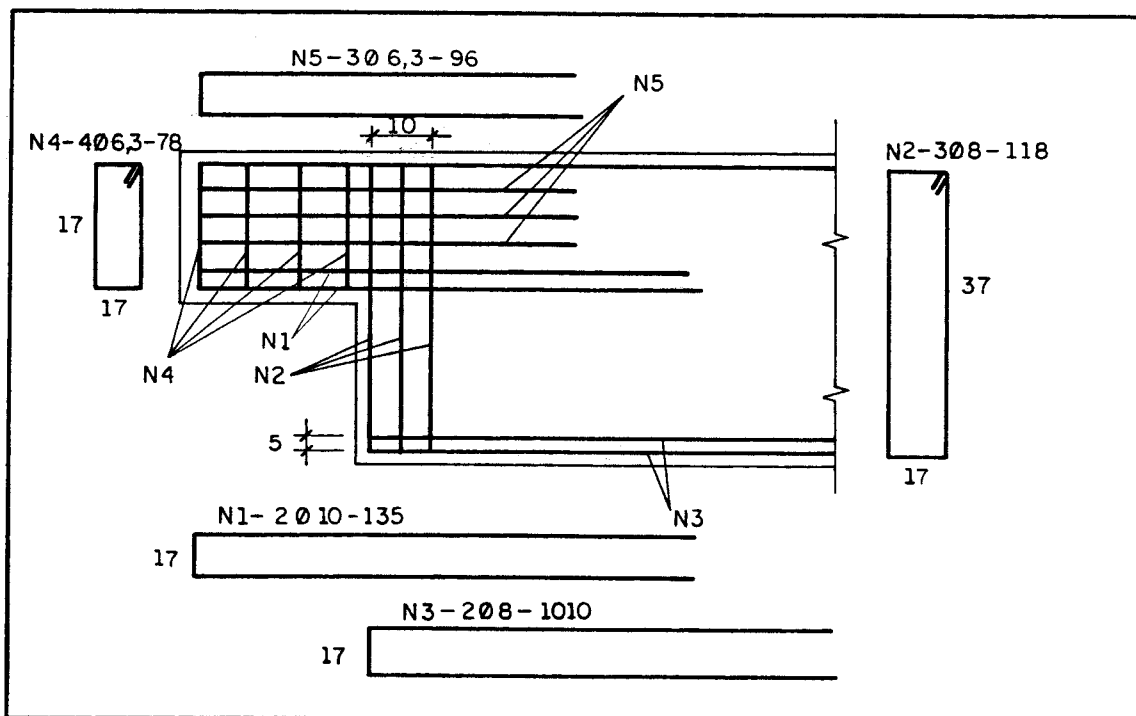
Detalhamento do apoio em dente do exemplo 8.
